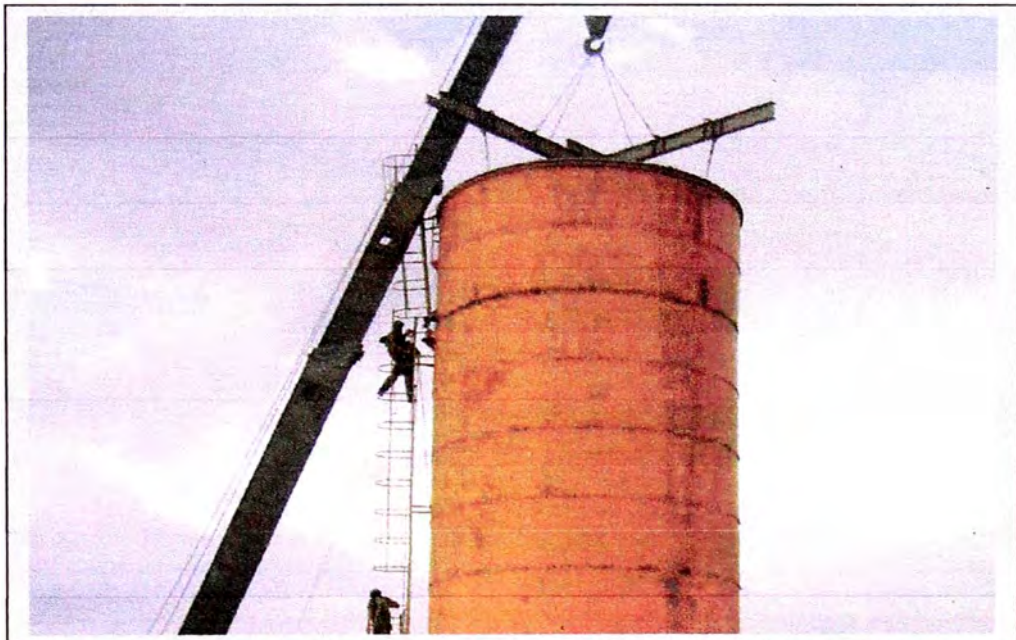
Colocado de machina para instalar gata de botella de 30 ton y retirar el anillo posición 4
